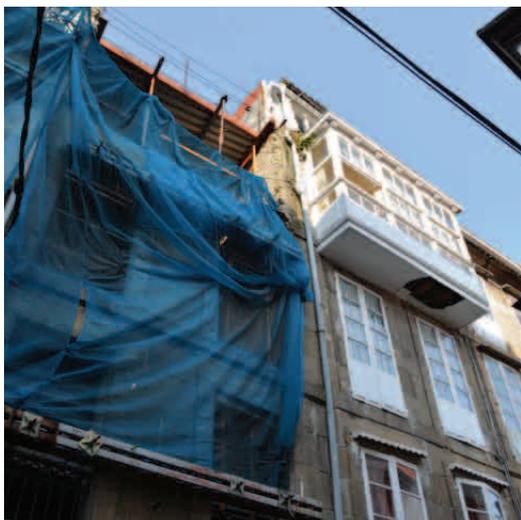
Dos edificios en mal estado (fuente propia, c/Zapatería)
